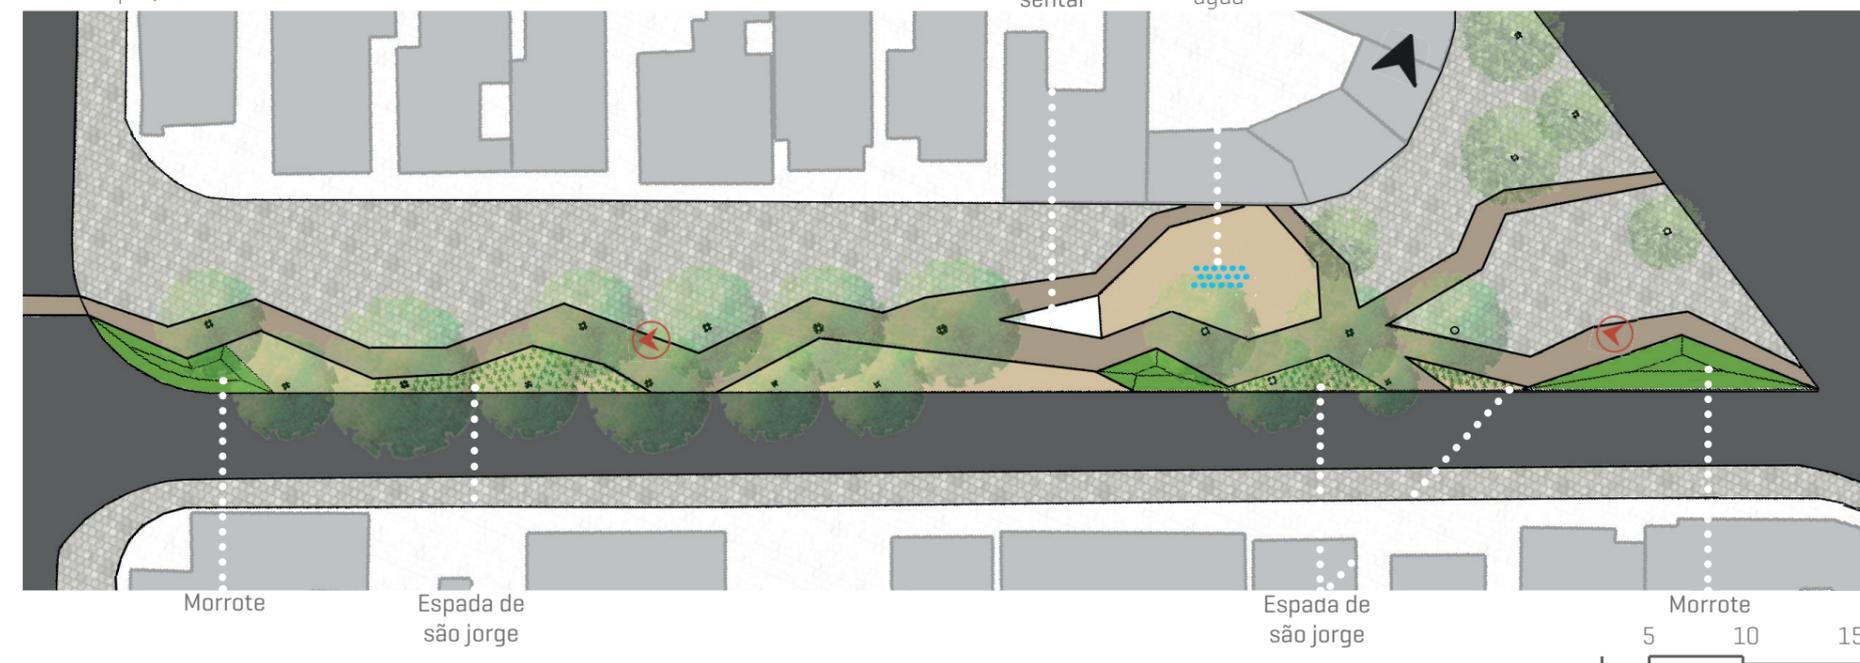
| Esquema explicativo da construção da proposta para o trecho 04
